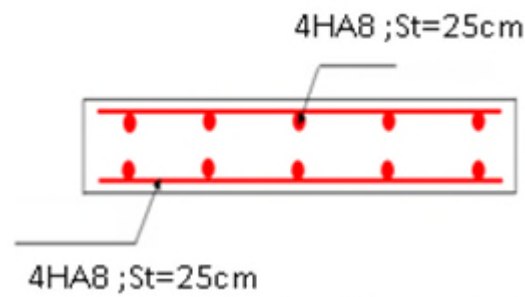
Schéma de ferrailage de la dalle sur 2 appuis
